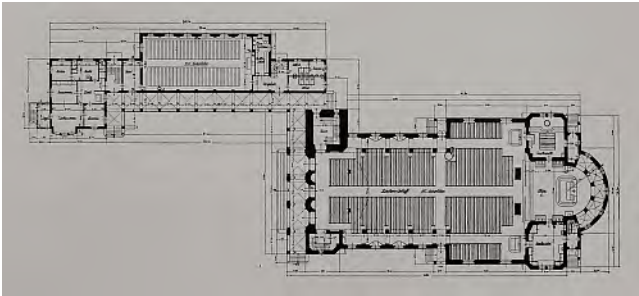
St. Gallen-Neudorf, St. Marien, Grundriss. – DCK 10 (1914), 301.
